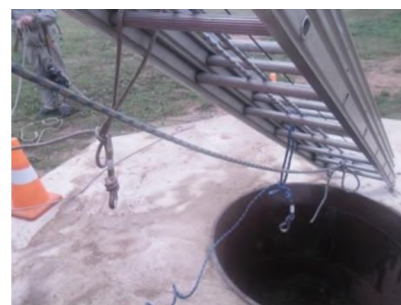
Закрепление рабочей и страховочной веревки за конструкцию
